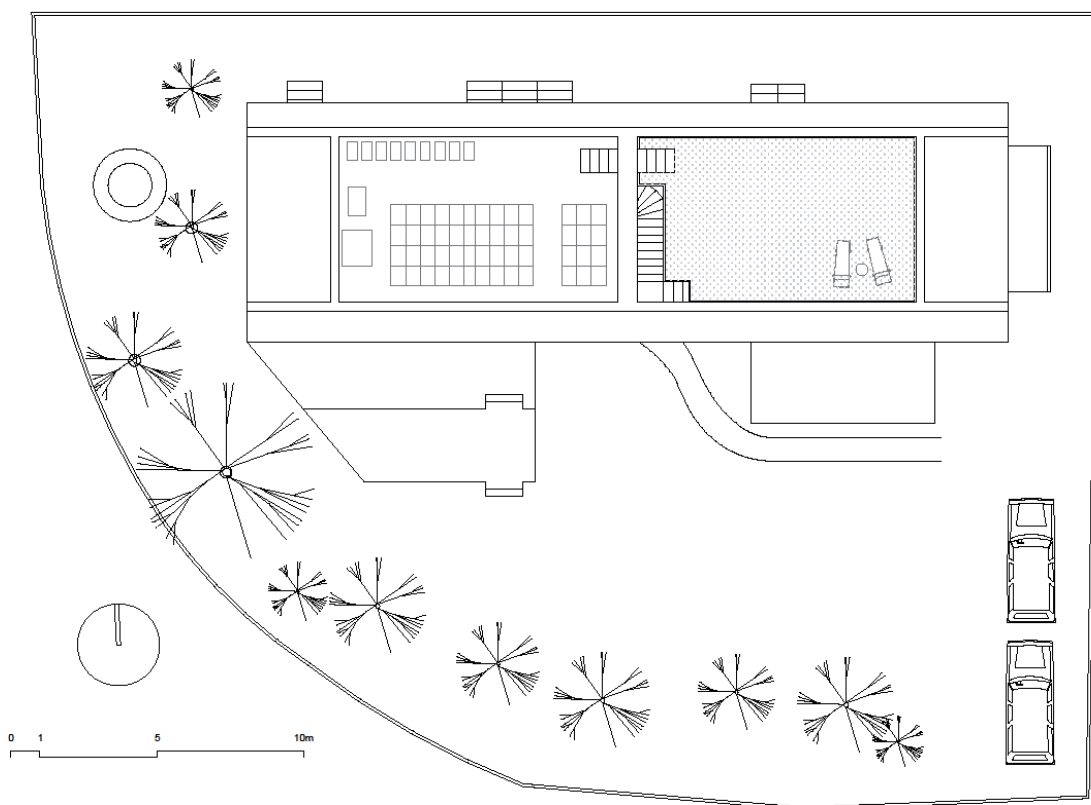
Planta cobertura (sem cor). Fonte: AUTOR (2017).
